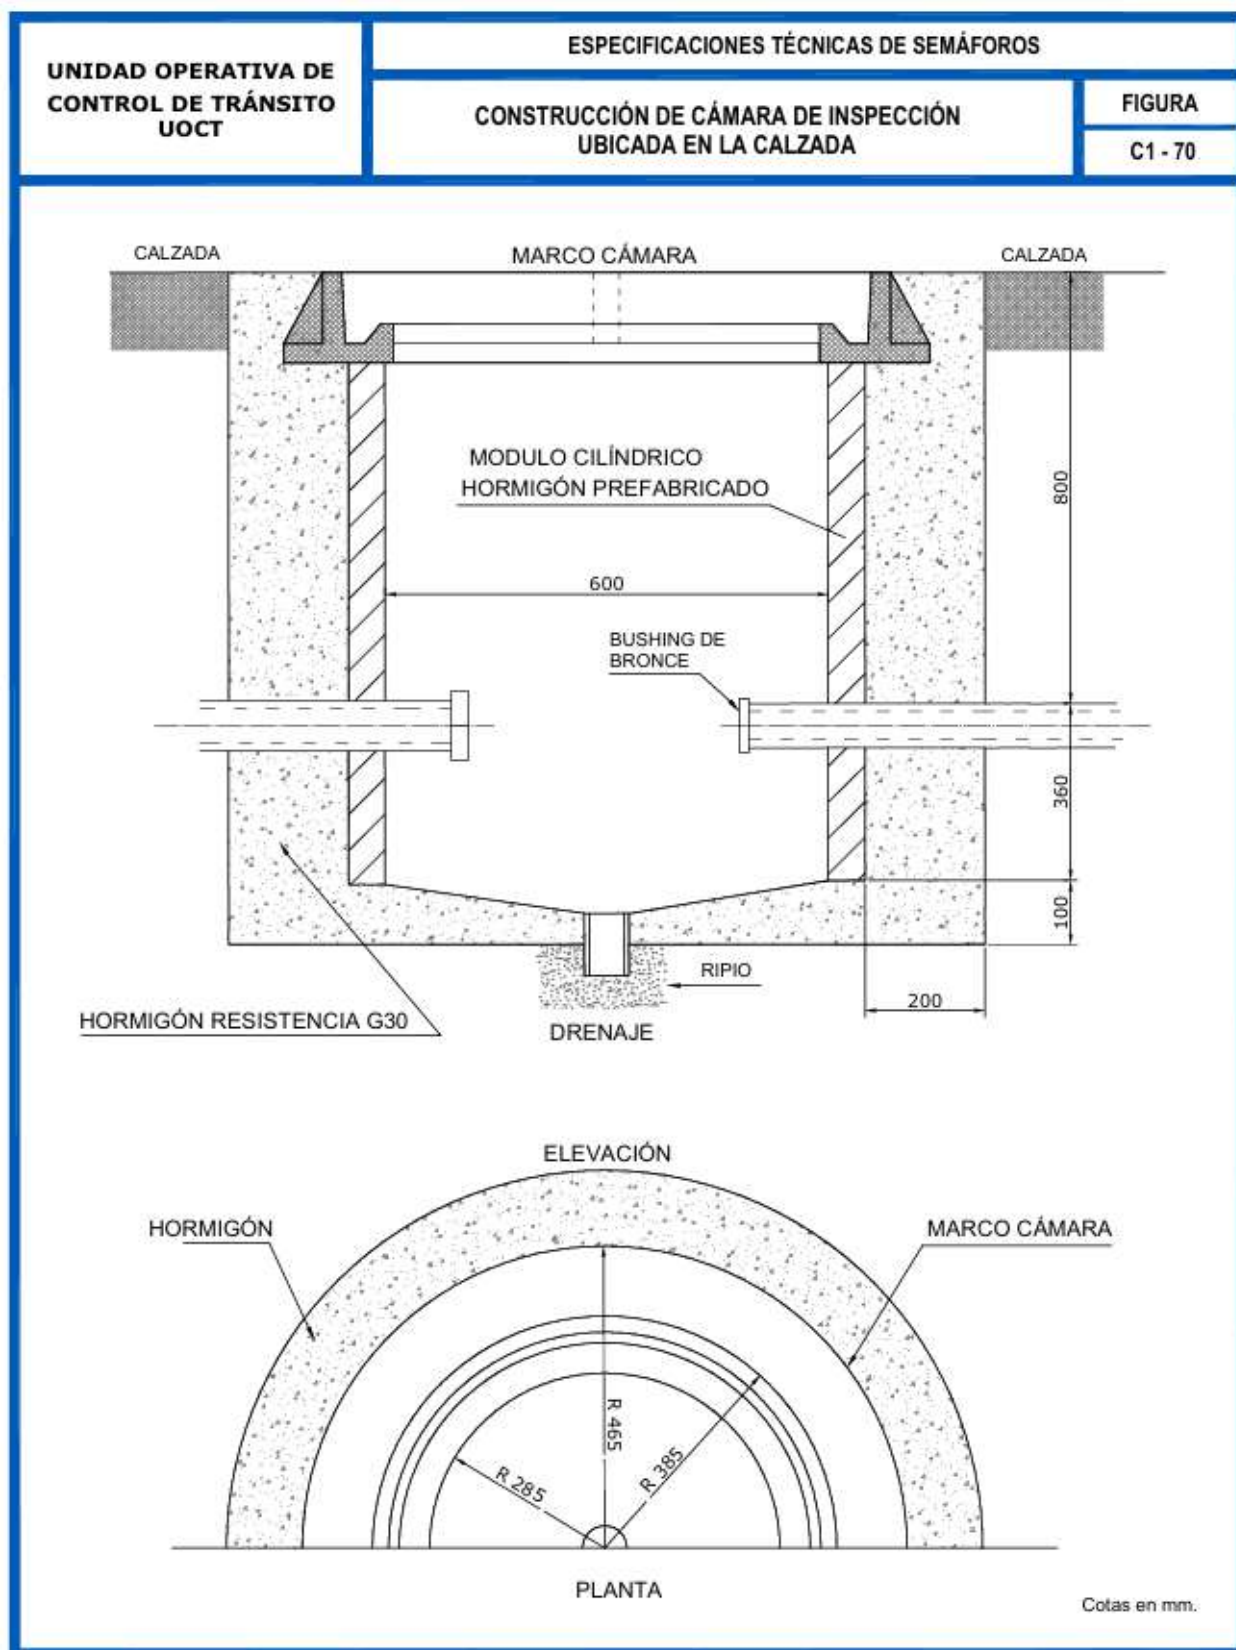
70 Construcción (Modificación) Cámara de Inspección Ubicada en la Calzada
